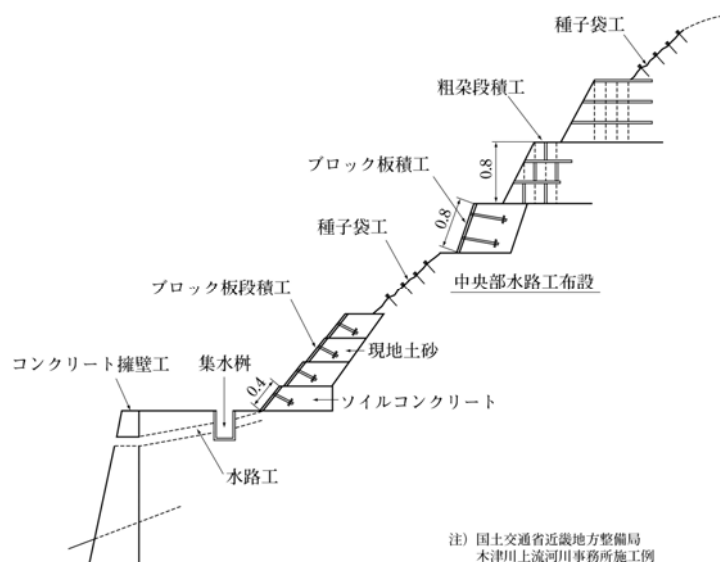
土留工を主とした山腹工（施工例）断面図
